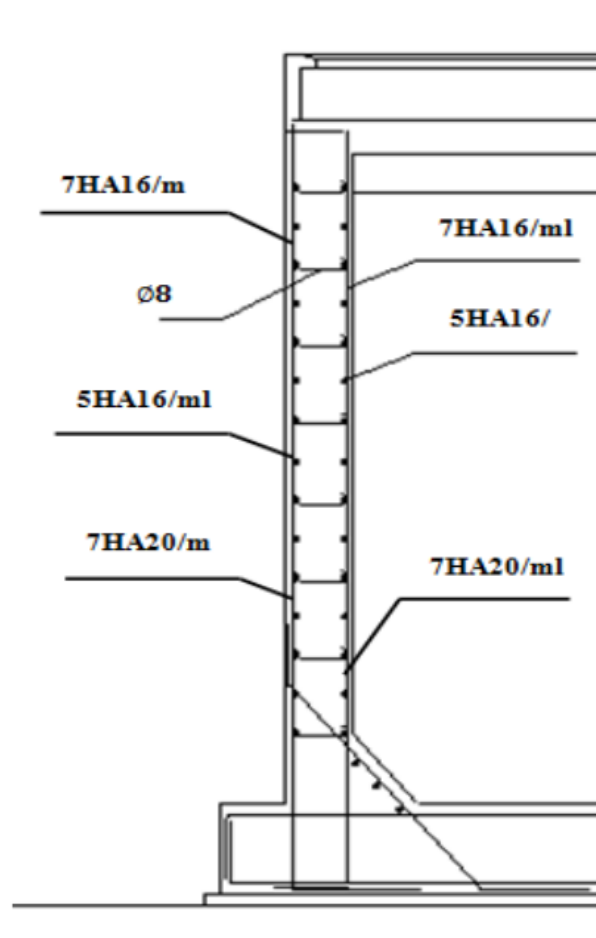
Ferrailage des voiles extérieurs aux appuis.
